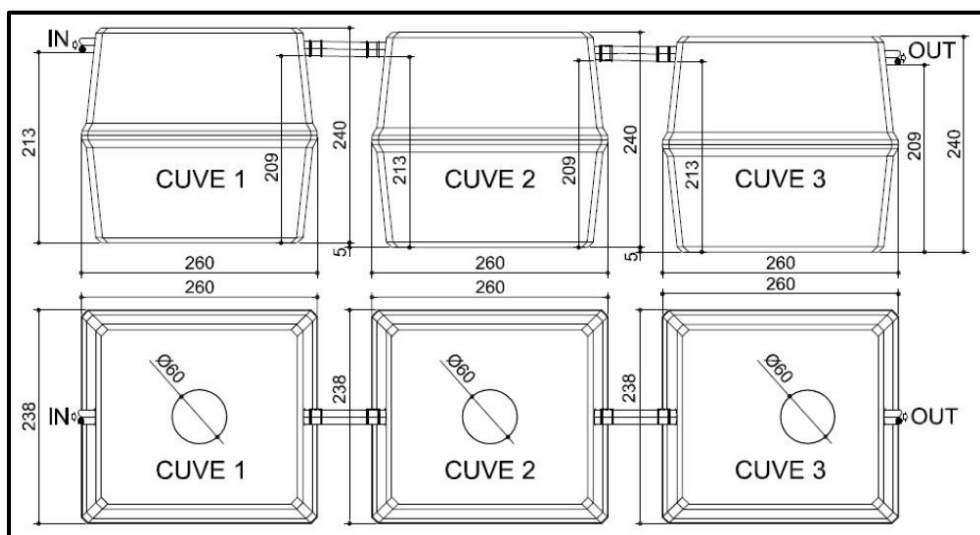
Plan d'encombrement de l'Oxyfix® C-90 CB 38 EH MB & CB
